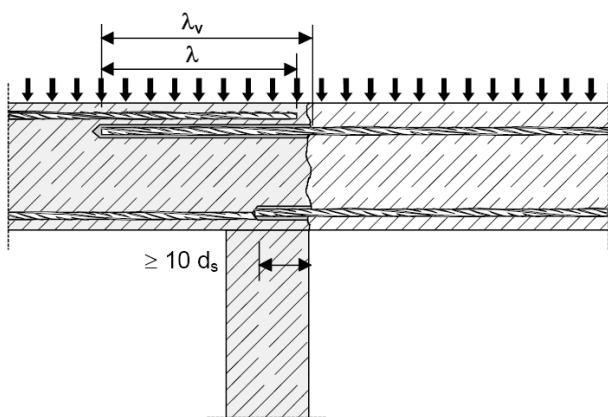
Ancrage en extrémités de dalles ou poutres en appui simple
